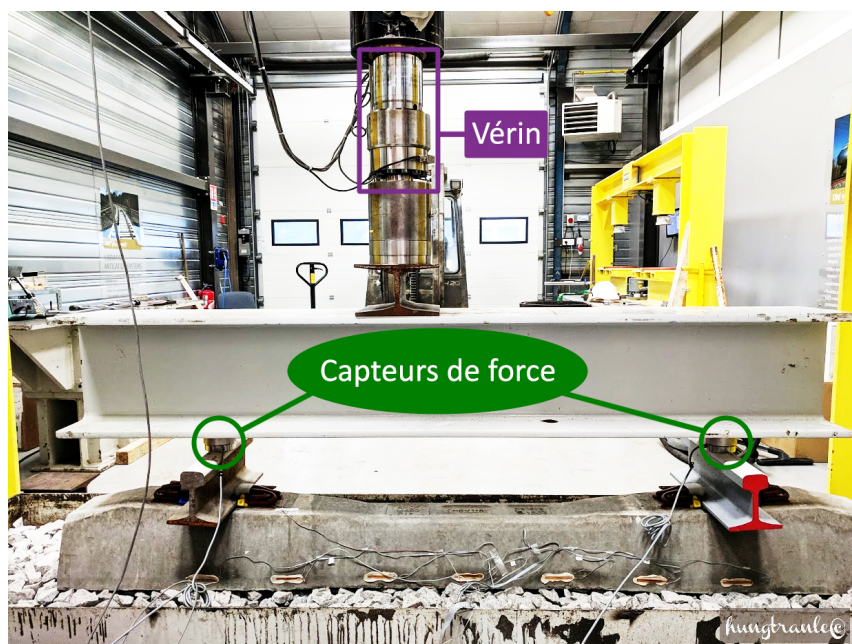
Dispositif d'essai de flexion d'une traverse posée dans une caisse de ballast (photo source : hungtranle©)
